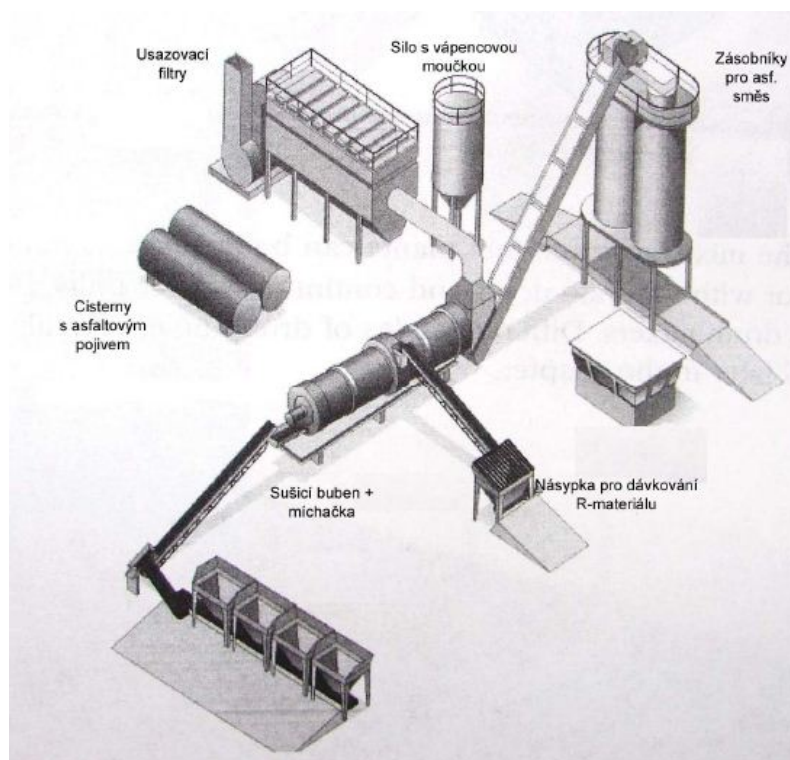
Předehřívání R-materiálu, převzato z [12]
